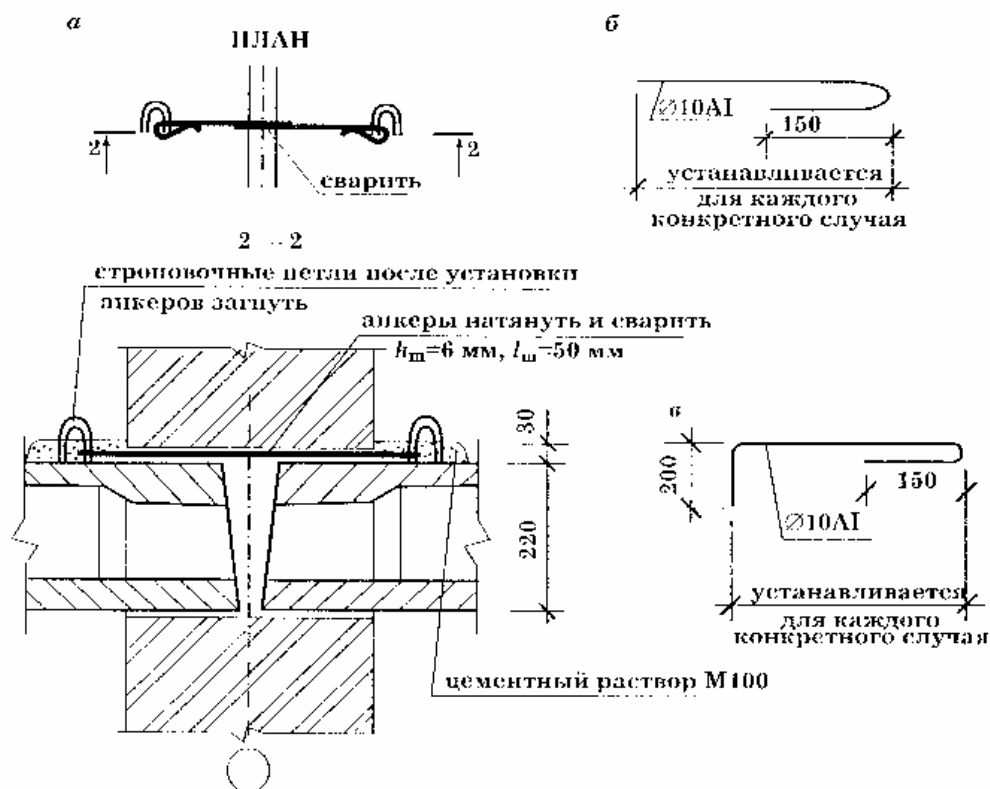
Анкеровка плит перекрытий арматурными стержнями:
